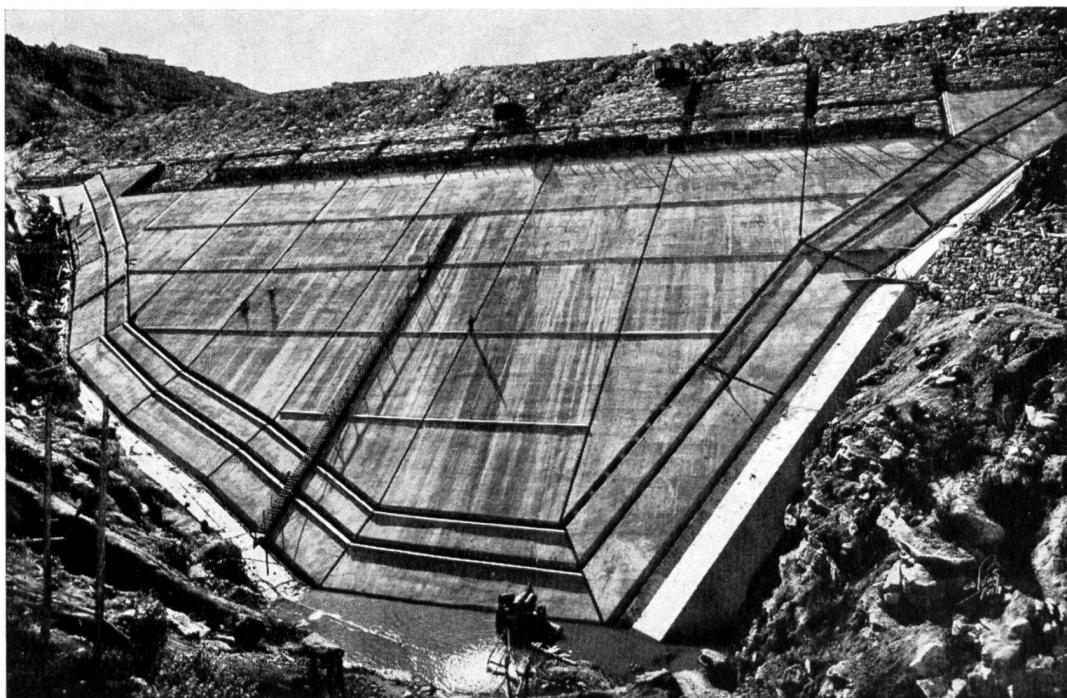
Paradela-Damm, Portugal. Höchster Erddamm mit Oberflächendichtung.
